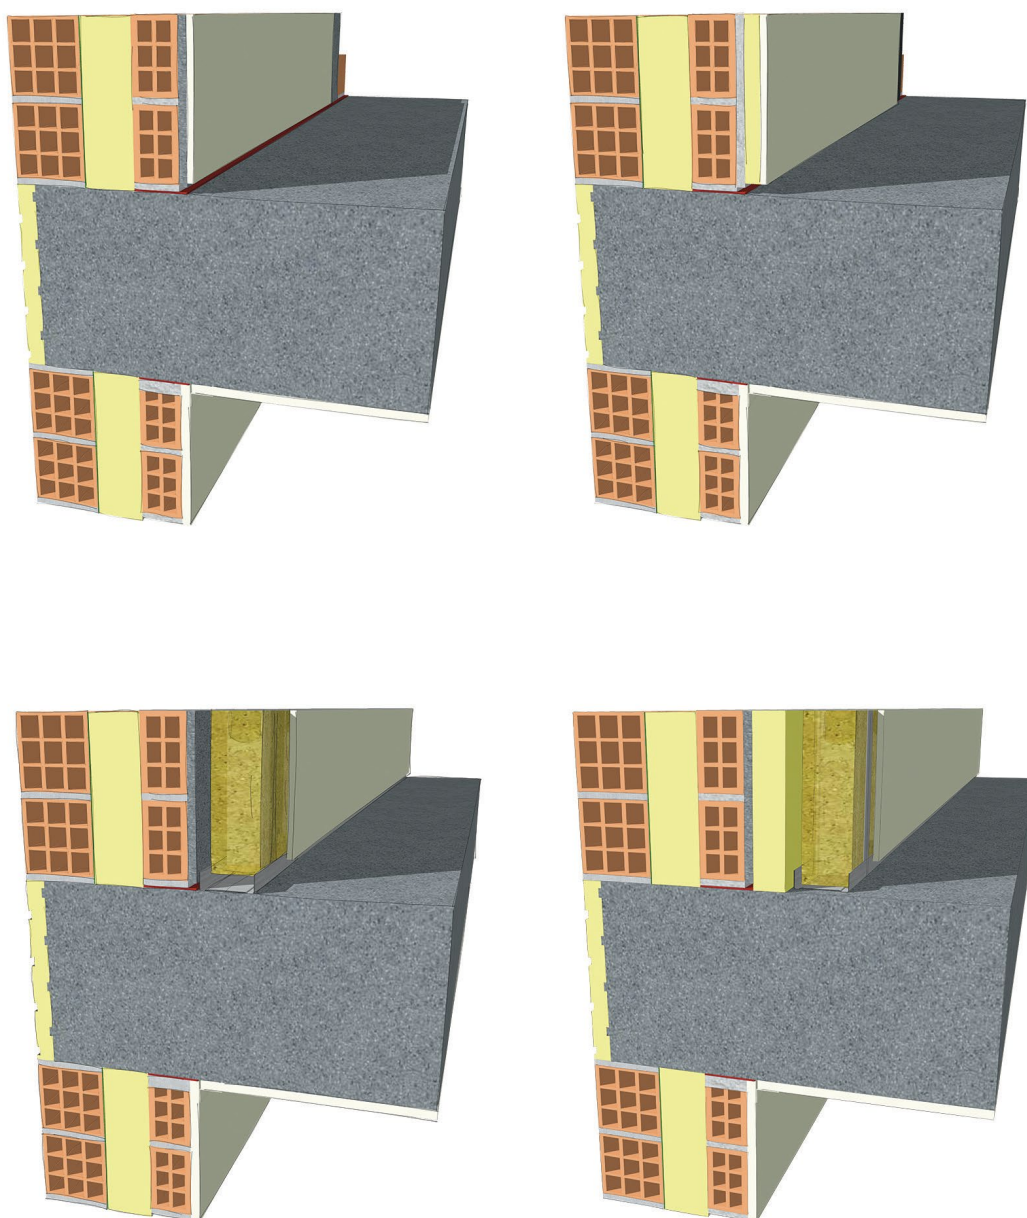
Detalle de izquierda a derecha: estado inicial; trasdosado directo; trasdosado con subestructura y aislamiento; y trasdosado con subestructura separada de la pared y dos tipos de aislamiento.
